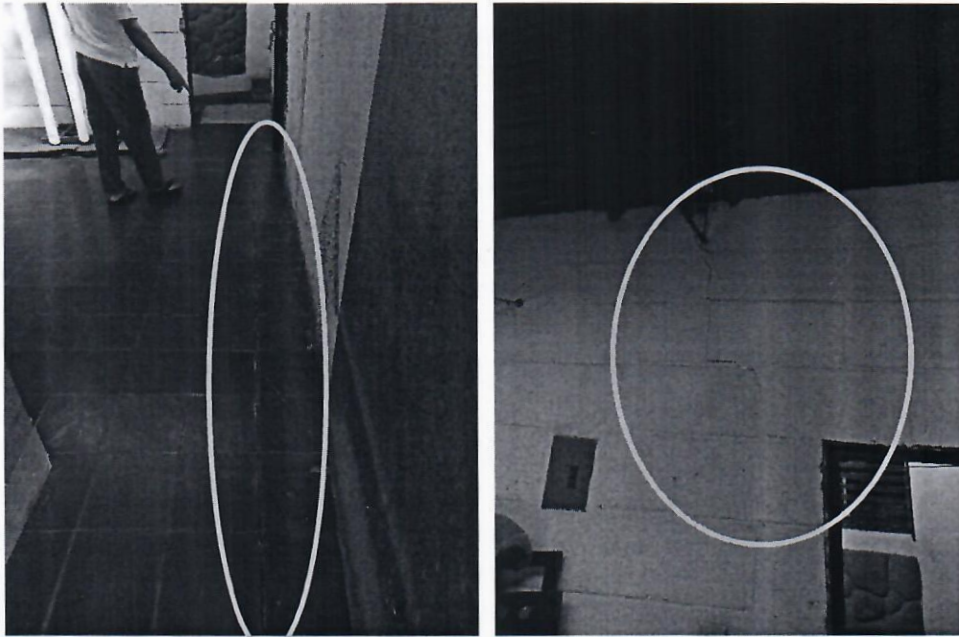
Vista interna de vivienda (zona mostrada en Figura 4) en donde se puede apreciar el surgimiento de grietas en piso y paredes estructurales
